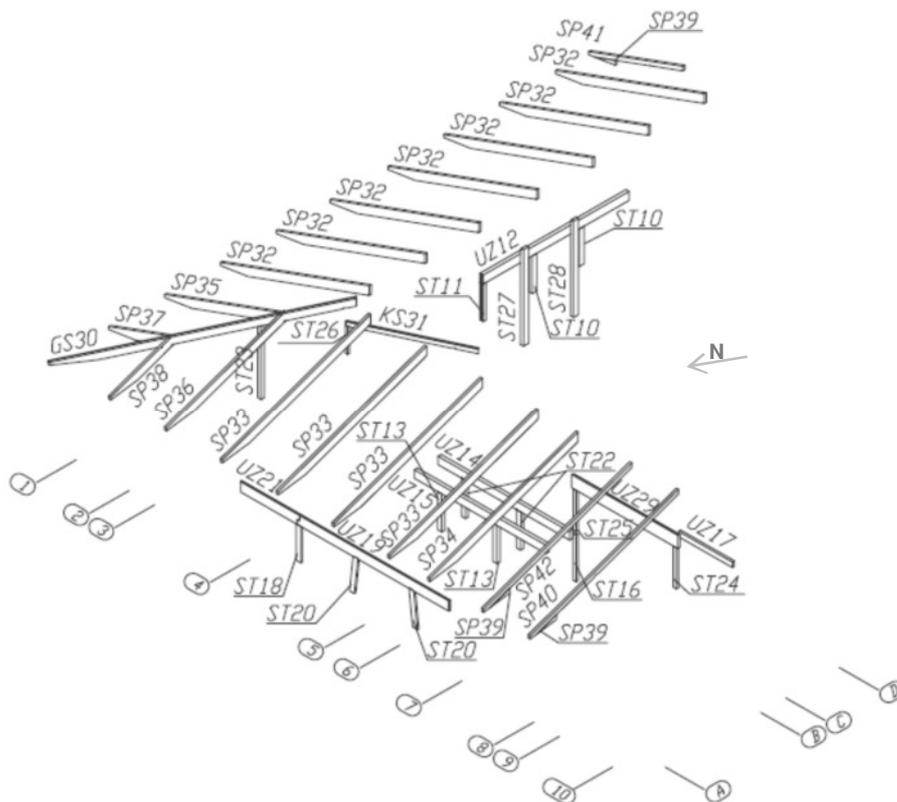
Axonometrie-Darstellung der Dachkonstruktion aus Dachträgern, Dachsparren, Stützen und Unterzügen mit zugehörigen Positionsnummern
